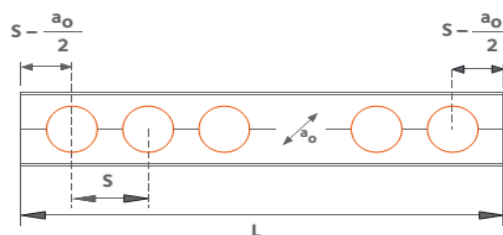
Poutres à ouvertures d'âme traditionnelle.
